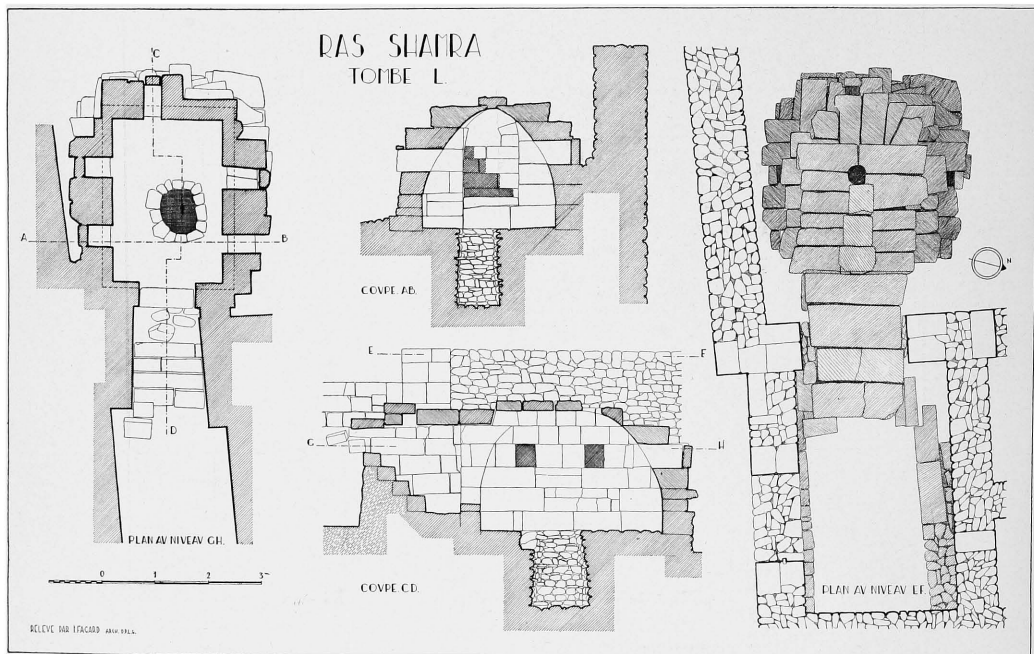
Plan et coupes du caveau L (p. 77, 86, 88).
